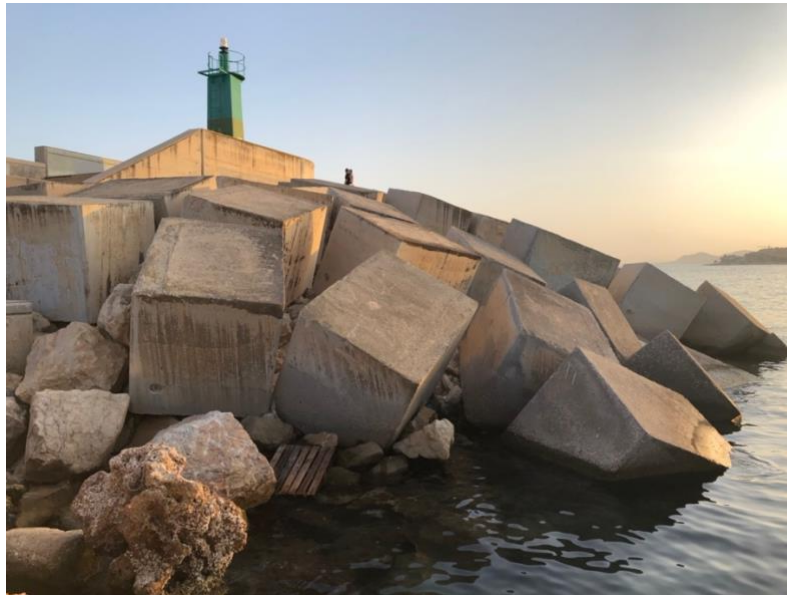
Manto de bloques de hormigón armado en el morro del puerto de Villajoyosa.
